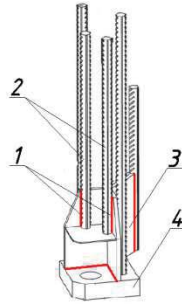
Конструкція відомих закладних деталей системи кріплень залізобетонних колон: 1 – зварювальний шов, 2 – анкерні стрижні, 3 – елемент, що забезпечує передачу навантаження від анкерних стрижнів до пластини кріплення, 4 – пластина кріплення.
